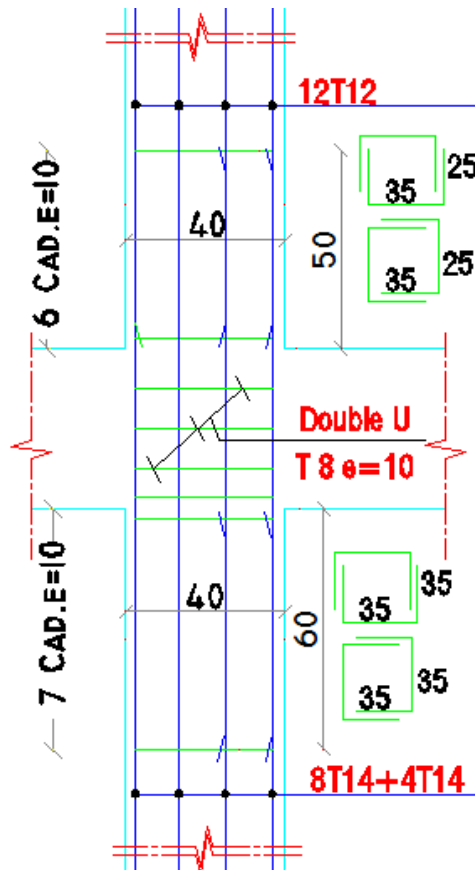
Ferrailage de recouvrement des poteaux (40x40) cm<sup>2</sup> et (40x30) cm<sup>2</sup>.
